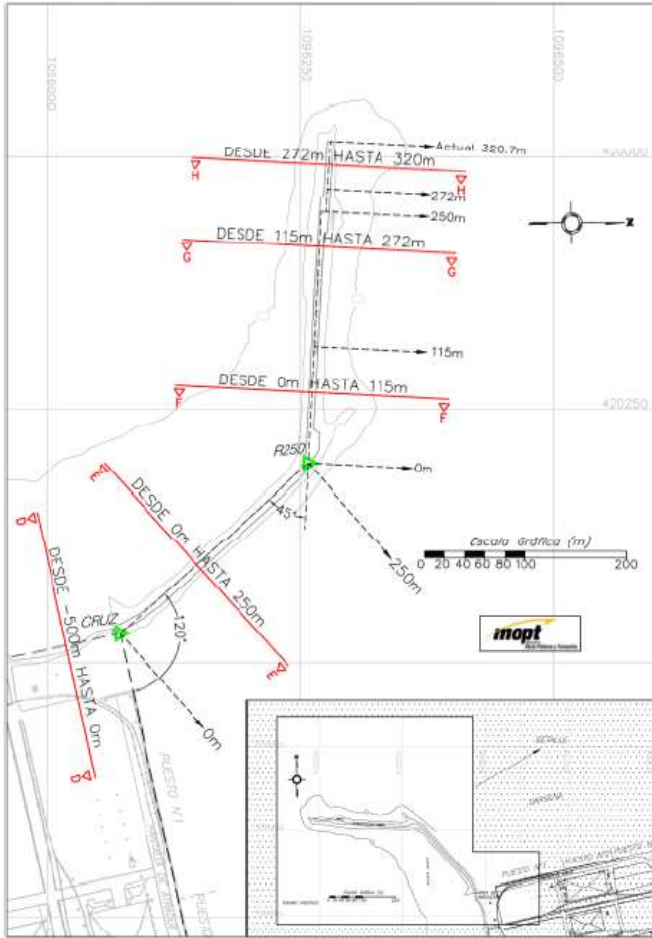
Planta y secciones del rompeolas de Caldera en 2012
